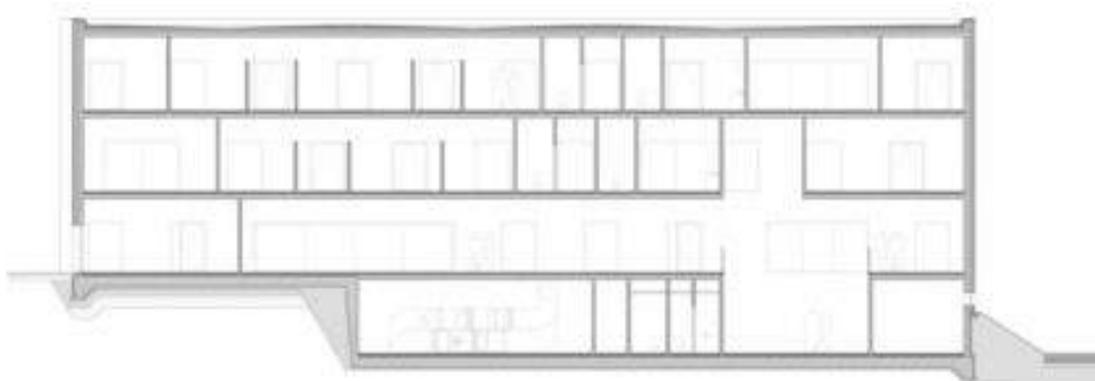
Corte del Proyecto, Centro de Negocios / PORT, Plataforma Arquitectura, Elaborado por PORT
